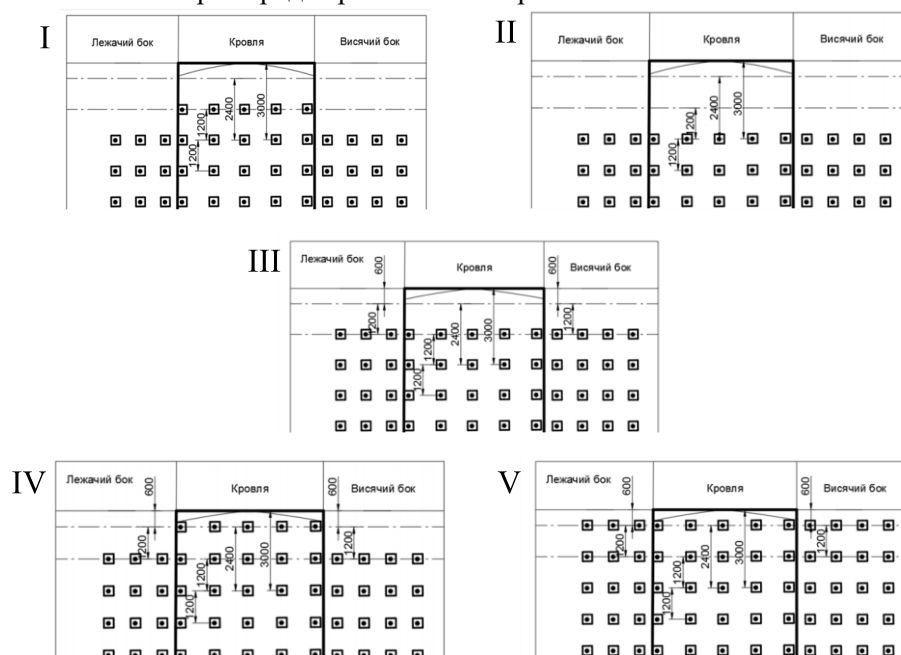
Технология крепления горной выработки с обнажением незакрепленной части кровли не более 3,0м (I-V - этапы крепления)
